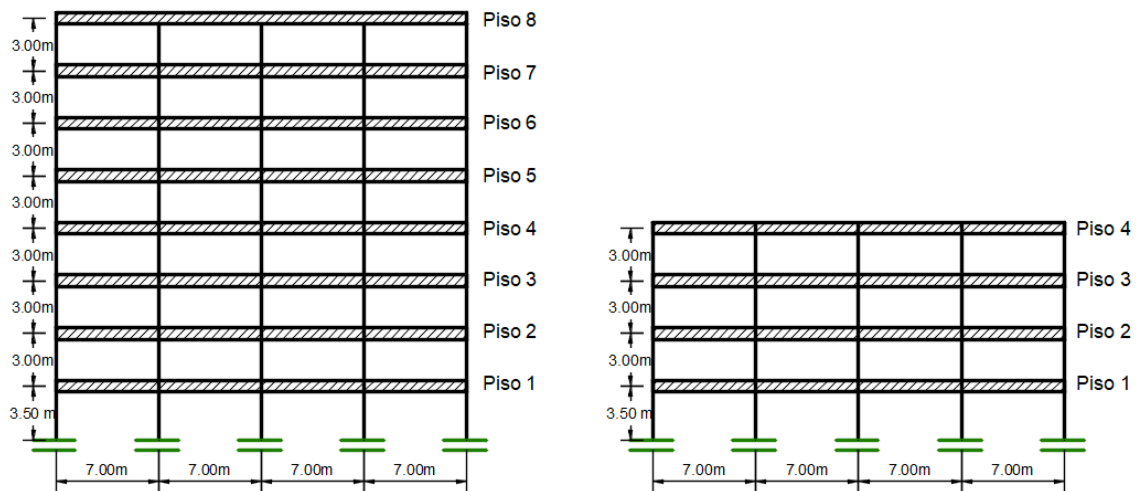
Modelo en elevación con 4 y 8 pisos para cada planta típica
